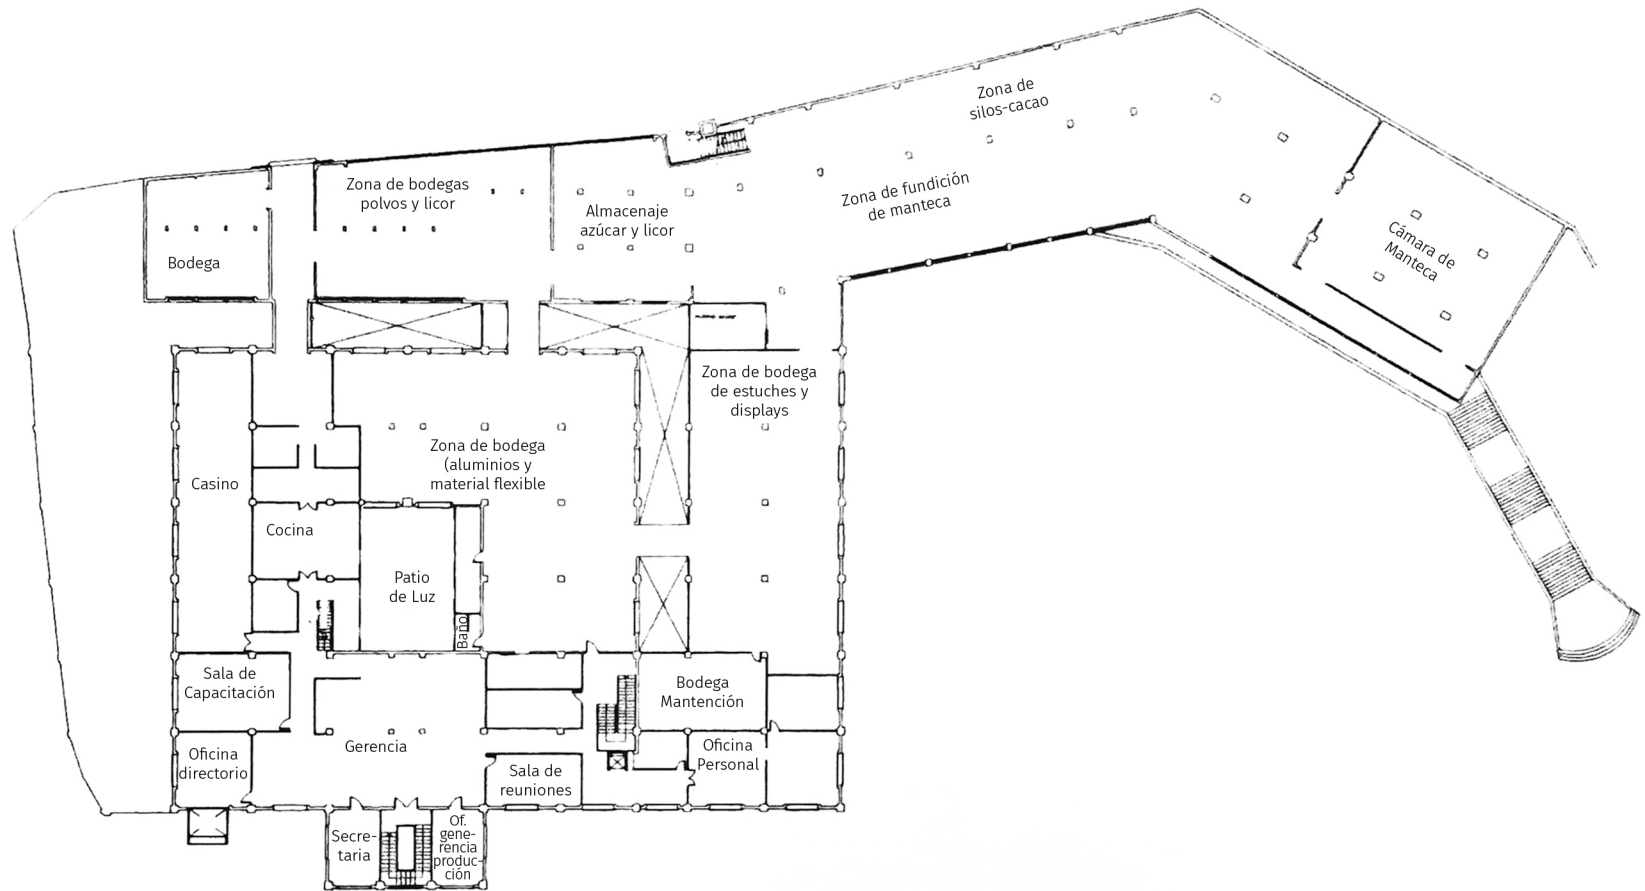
Planimetrías originales de la fábrica
